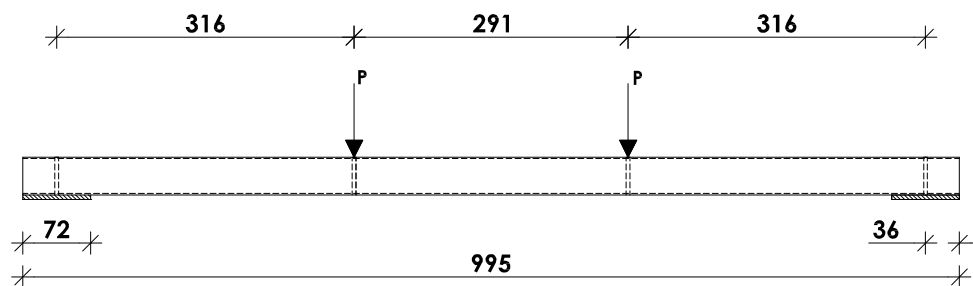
Alçado do ensaio tipo 90×1.5\_Fz2\_Liso (dimensões em mm).
